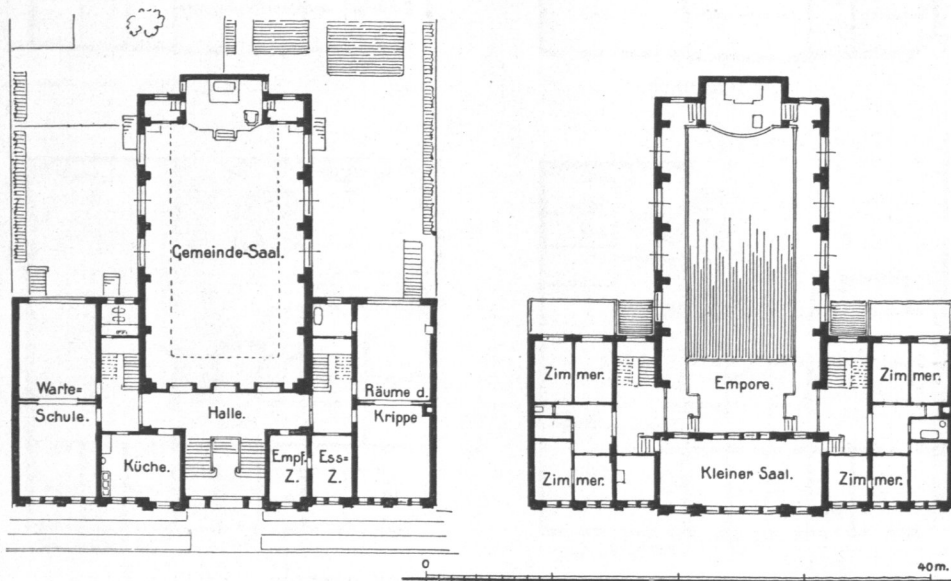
und 156. Gemeindehaus in Eilbeck, Grundrisse.
